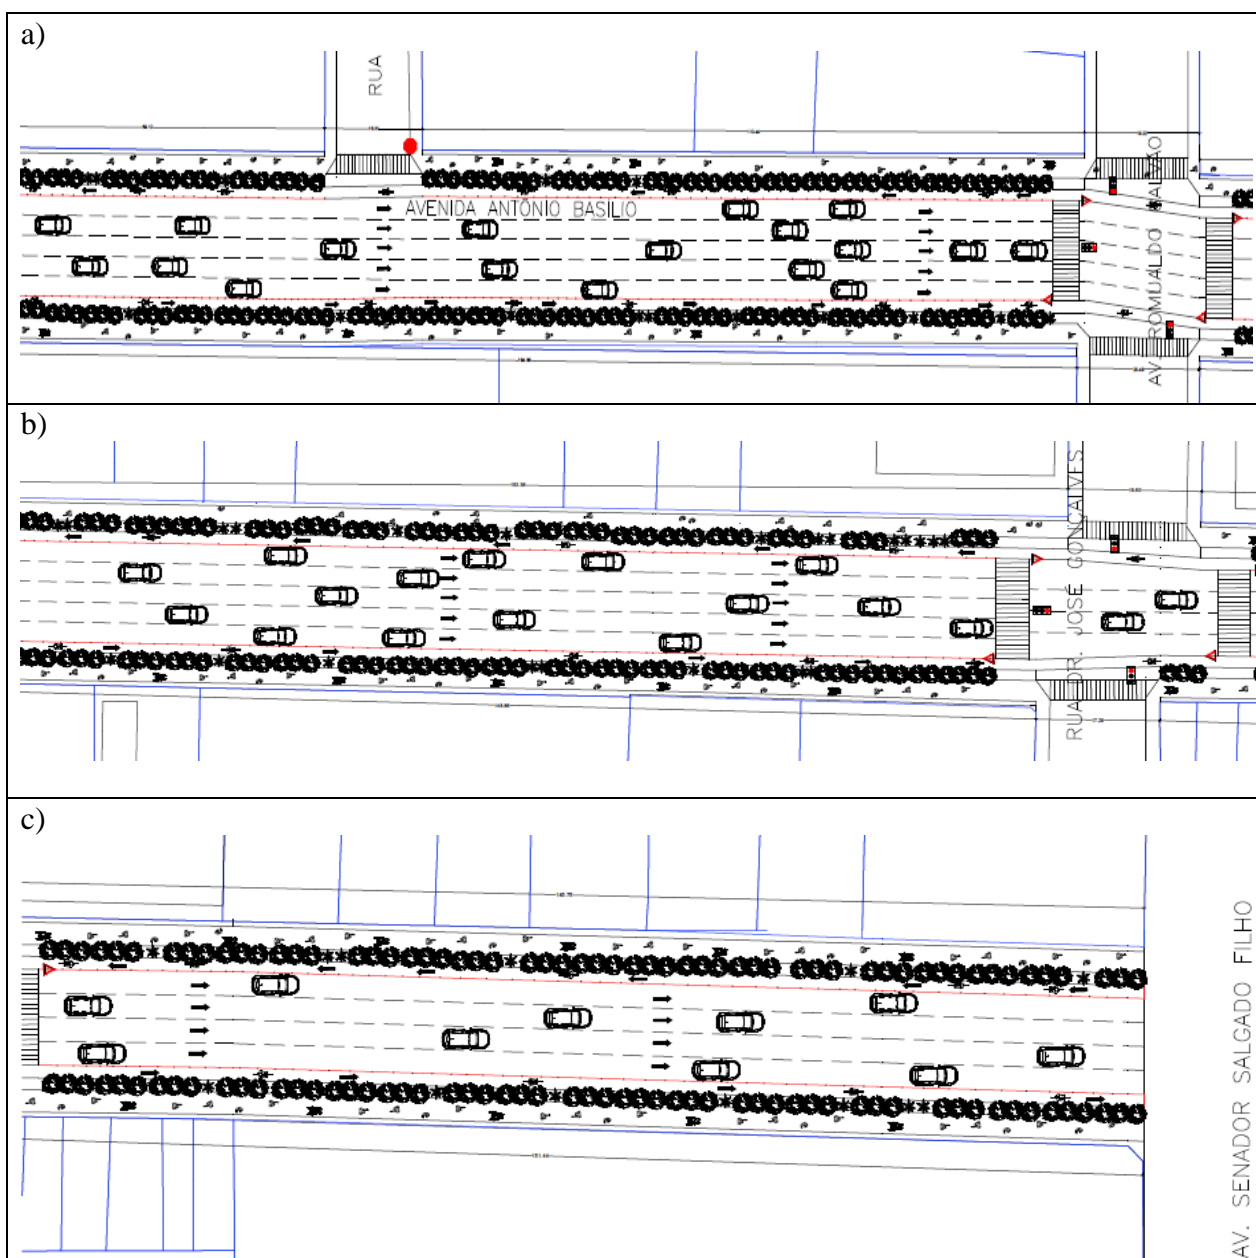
a) Planta baixa do projeto referente ao trecho 2. b) Planta baixa do projeto referente ao trecho 3. c) Planta baixa do projeto referente ao trecho 4.
